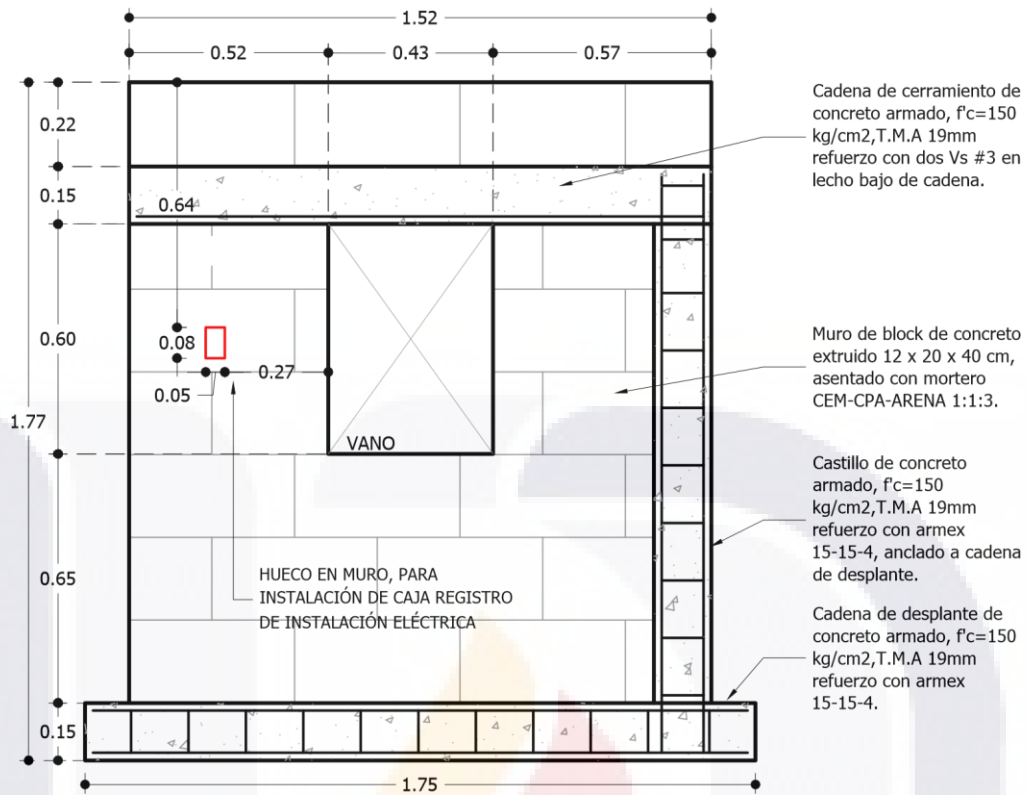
Detalle constructivo de diseño de MBC 2 Cara A
